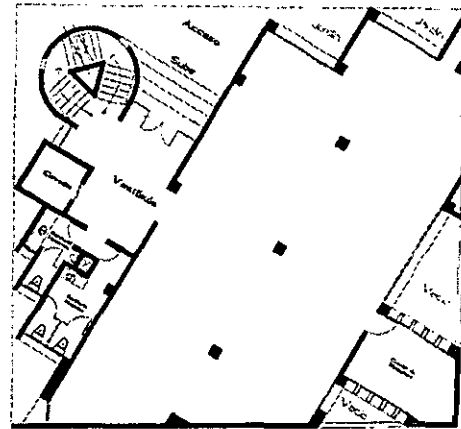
y 163 Casa Antonio Toca, plantas de acceso y baja (AOV).
